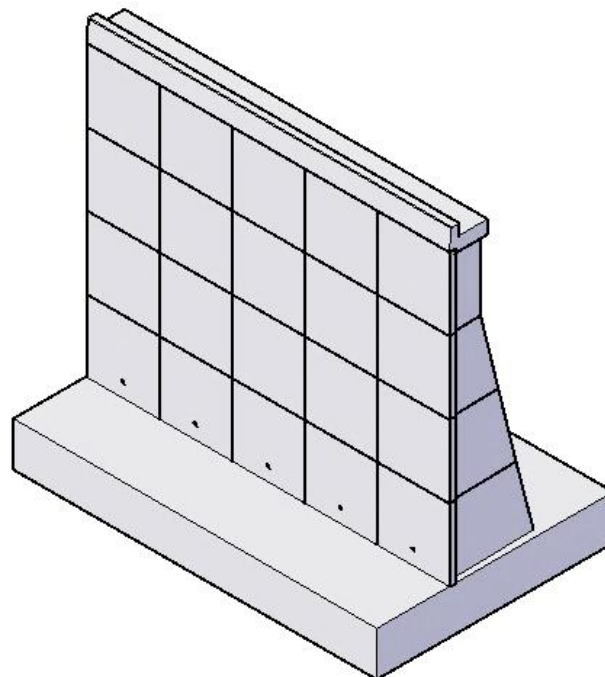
Vista 3D muro H=8,0m con paneles variables (Frente)
